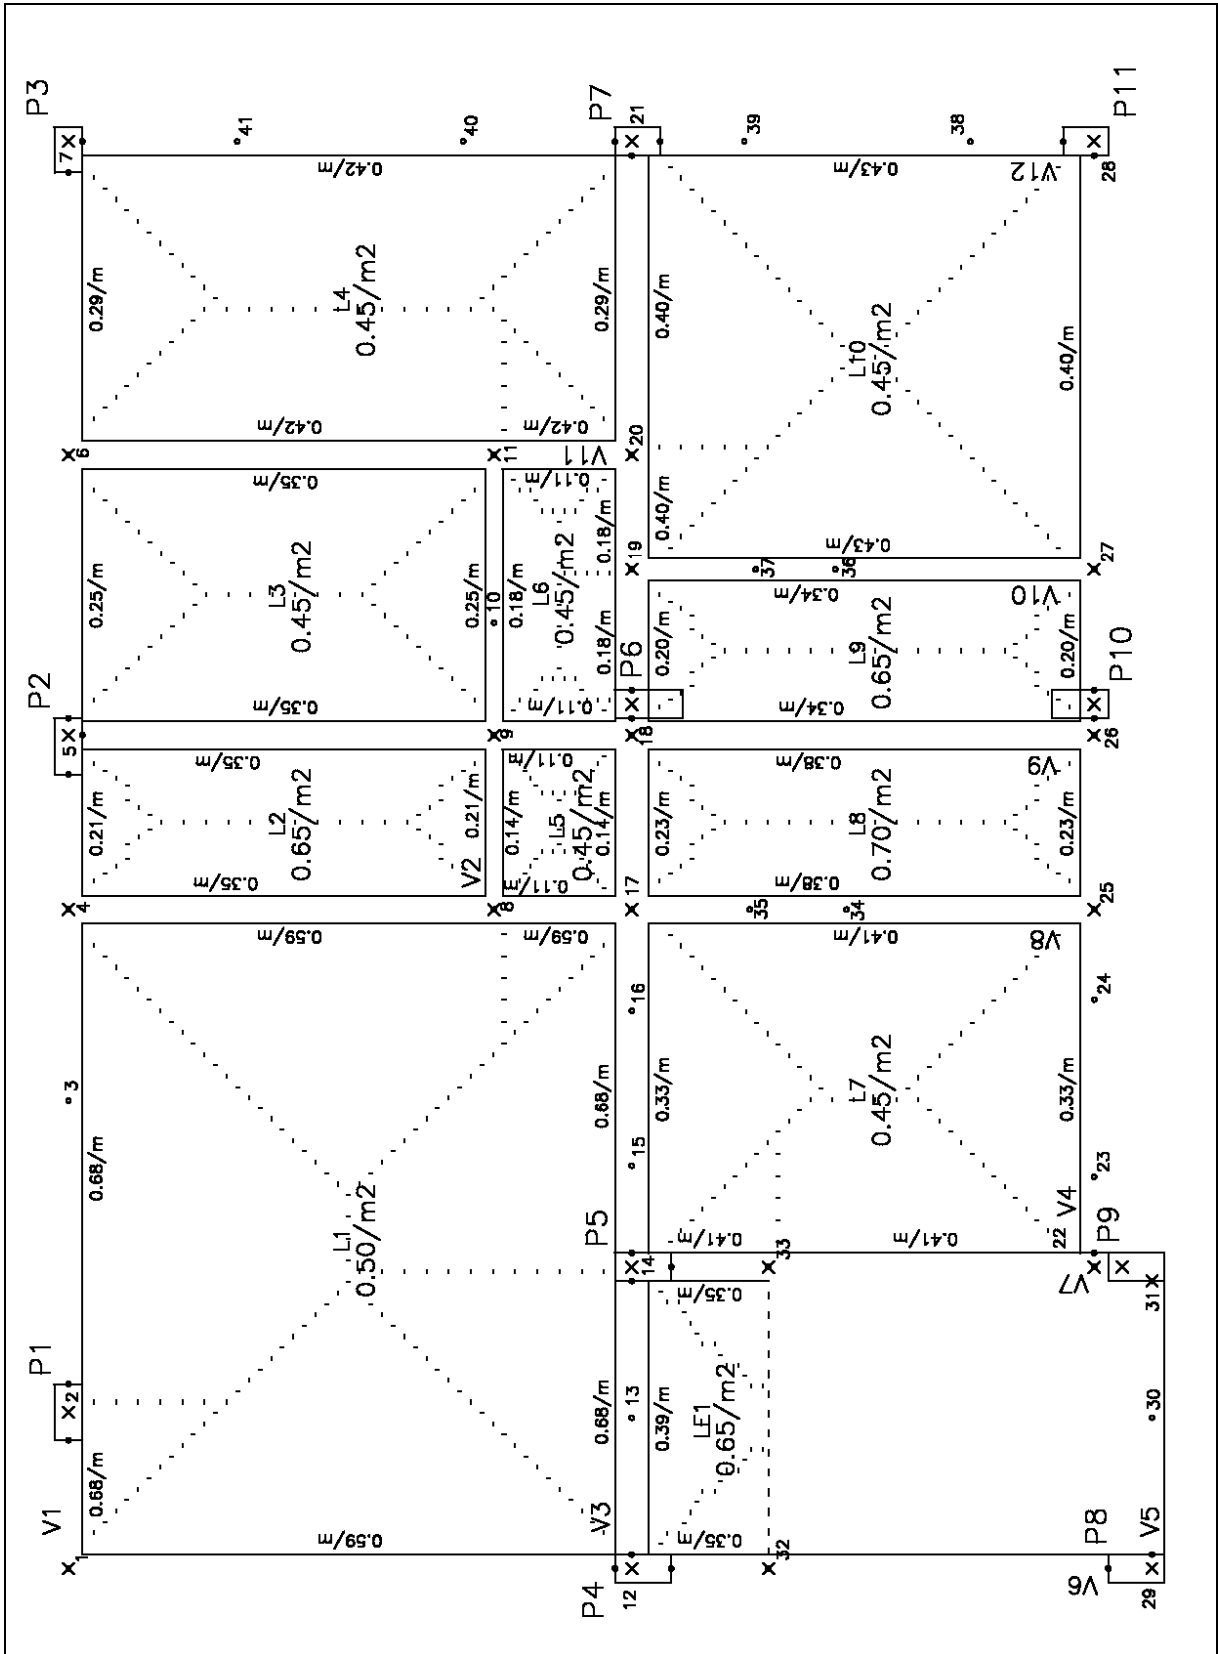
cargas distribuídas sobre as vigas oriundas das lajes do 2º, 3º e 4º pavimentos separadamente
